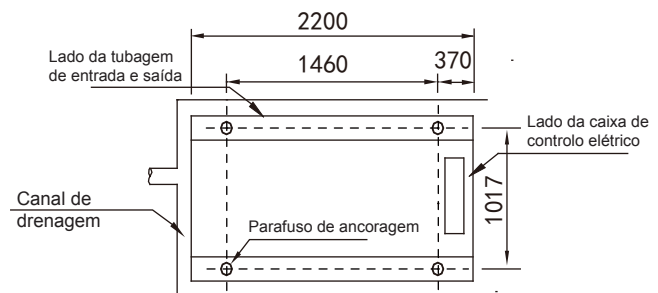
Vista superior do diagrama esquemático das dimensões de instalação do KEM-90 DRS5
